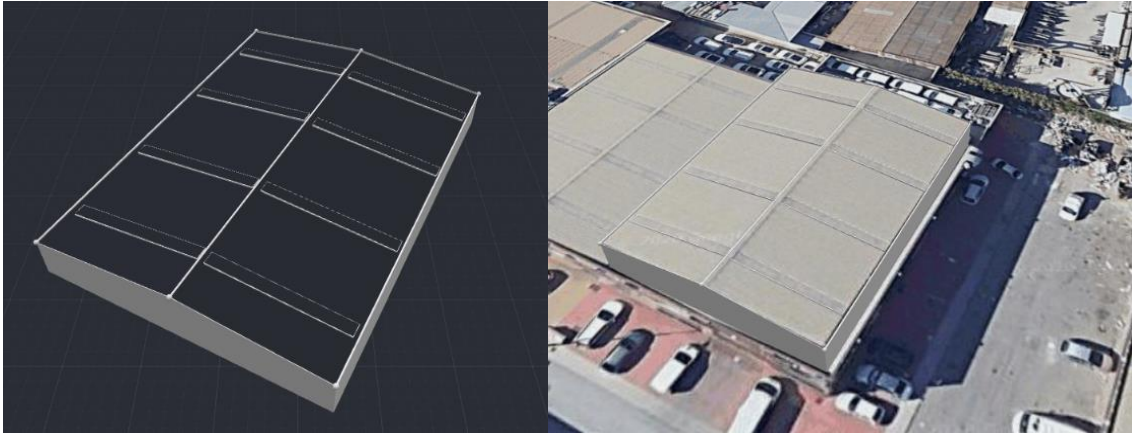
Dimensionado 2D de la cubierta y levantamiento 3D
